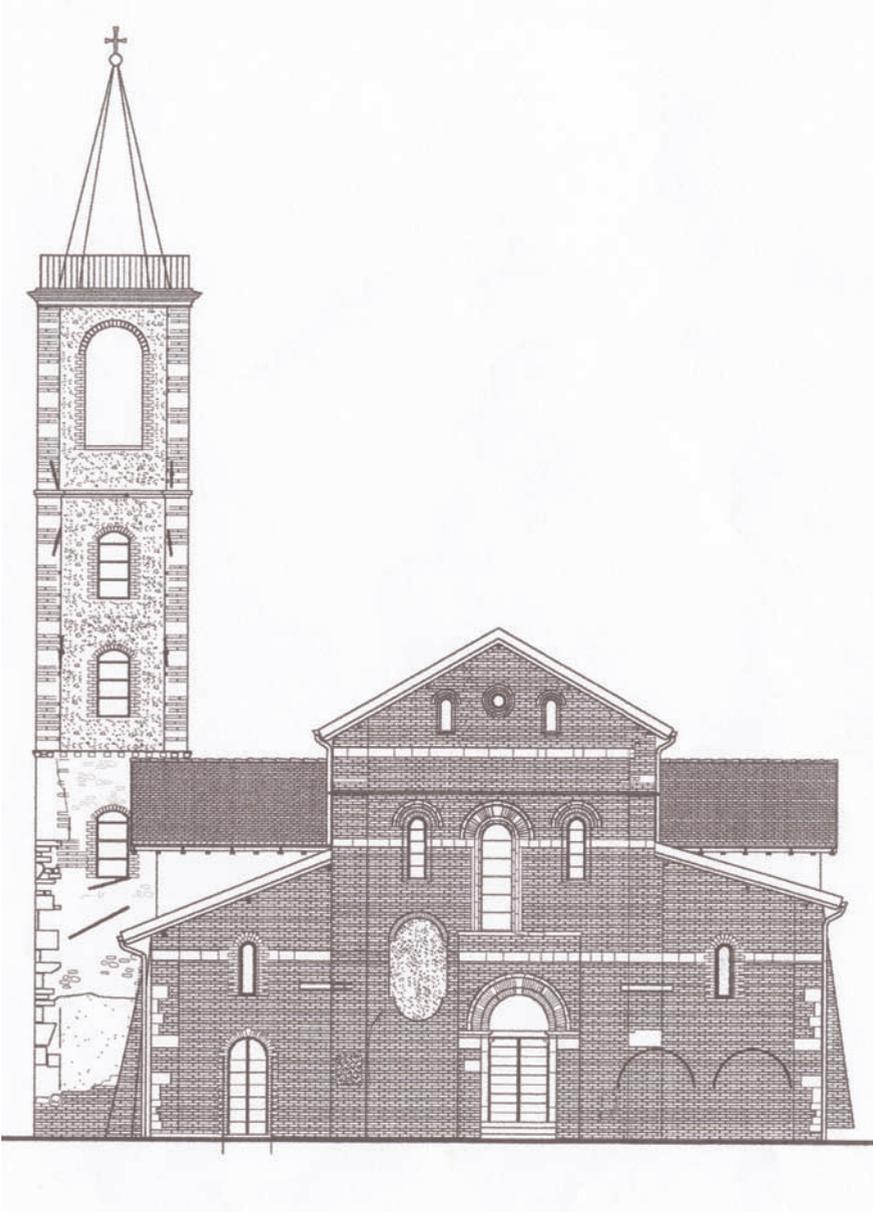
Tiglieto, chiesa di Santa Maria, prospetto ovest
